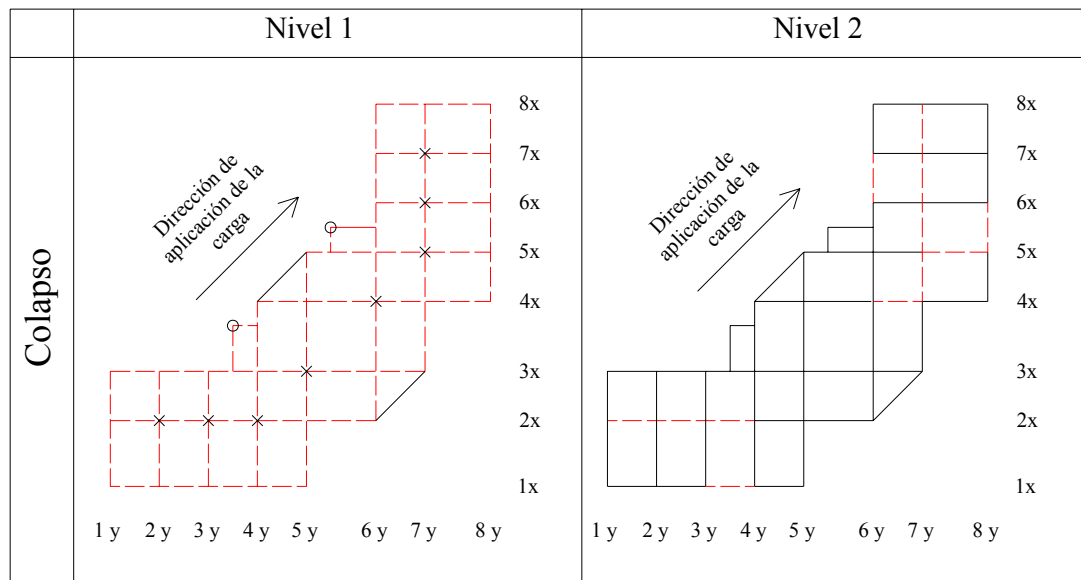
20 Vista en planta Niveles 1 y 2, para E.L. de CO.
